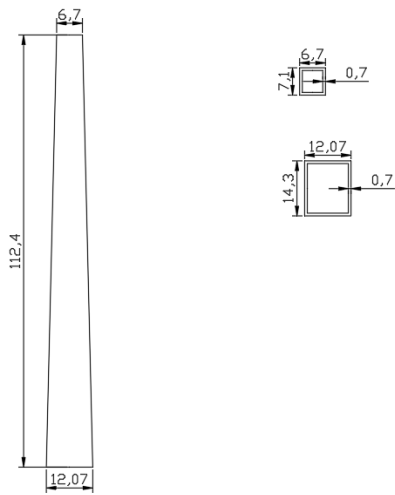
Pila 3. Perfil, Sección superior e inferior
